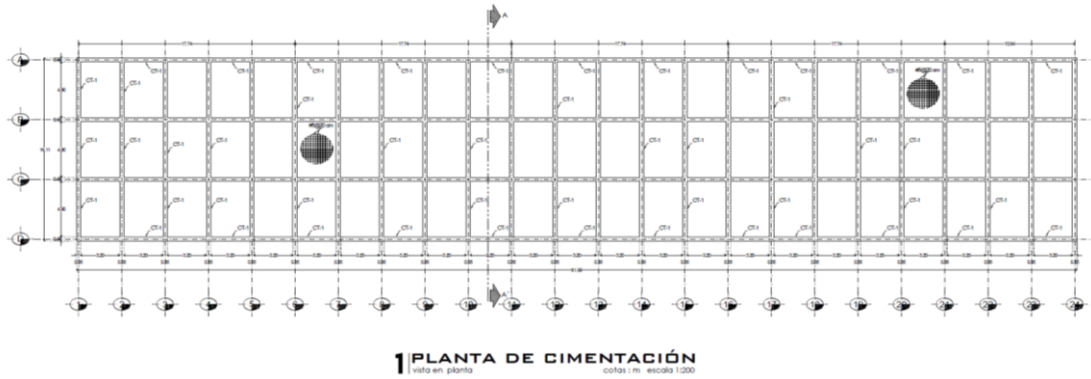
Arreglo de cimentación para la torre de enfriamiento (Vista en planta)
